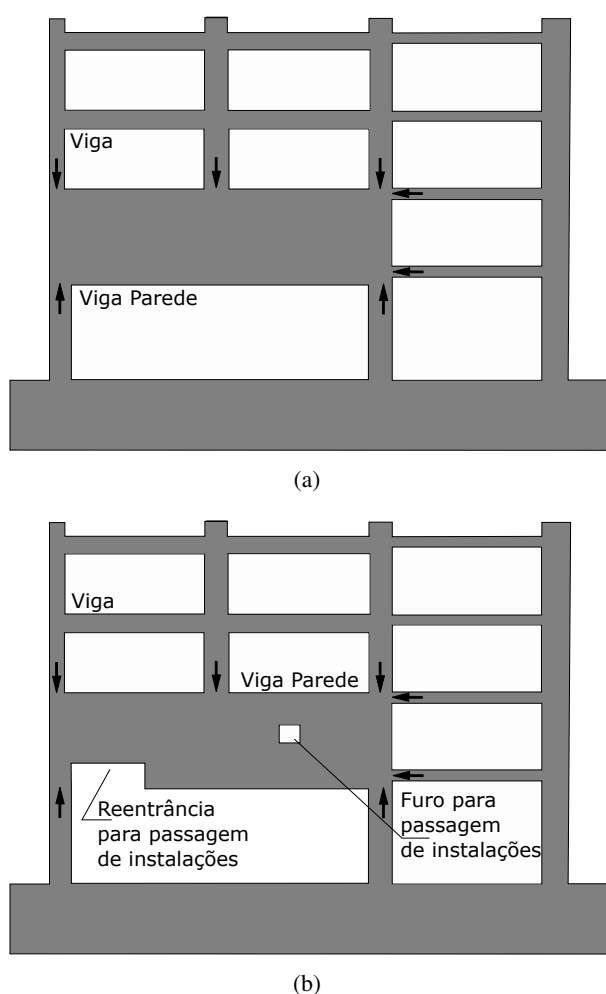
Vigas paredes em Edificações:(a)Viga Parede com geometria convencional;(b)Viga parede com geometria não convencional.
